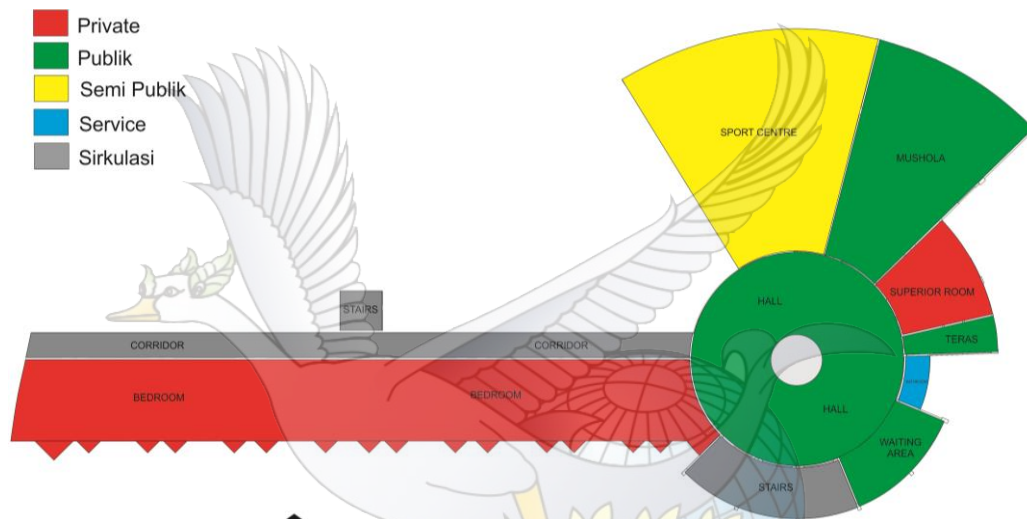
Master Plan Hotel Resort Pantai Klayar
